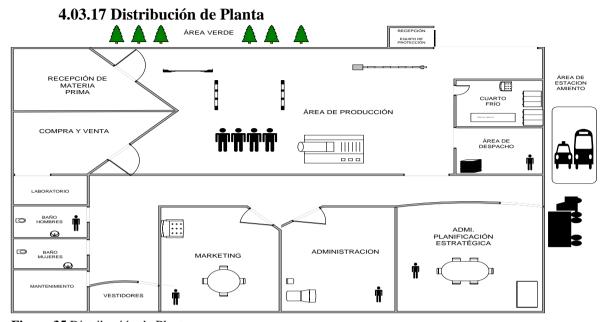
Distribución de Planta Elaborado por: Leonardo Ortega
